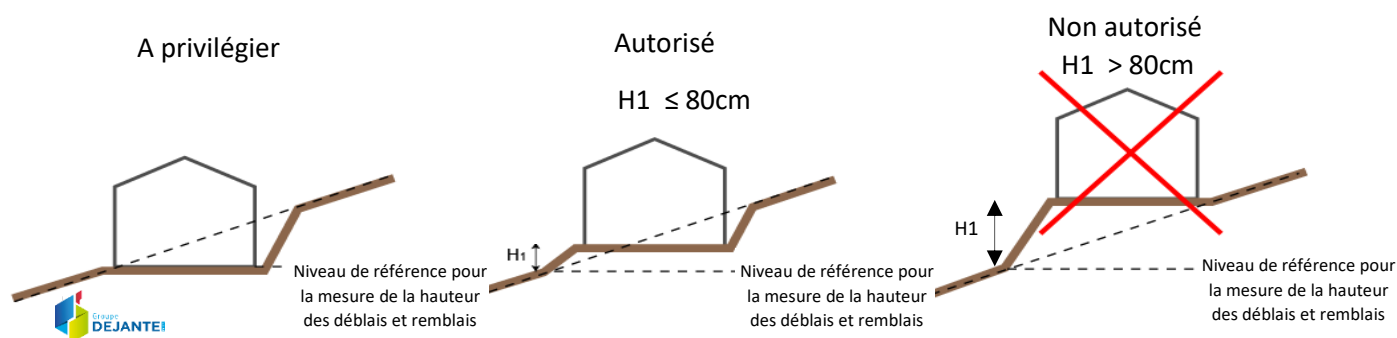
Règle générale pour l'implantation des constructions en zone Ua
